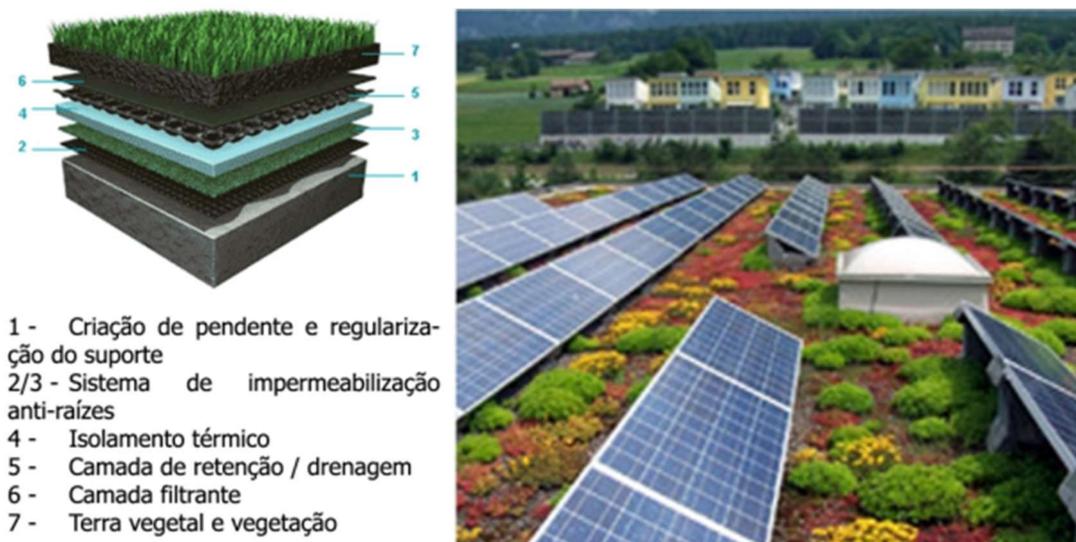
Sistemas construtivos de coberturas ajardinadas [Fonte: Sotecnisol].
